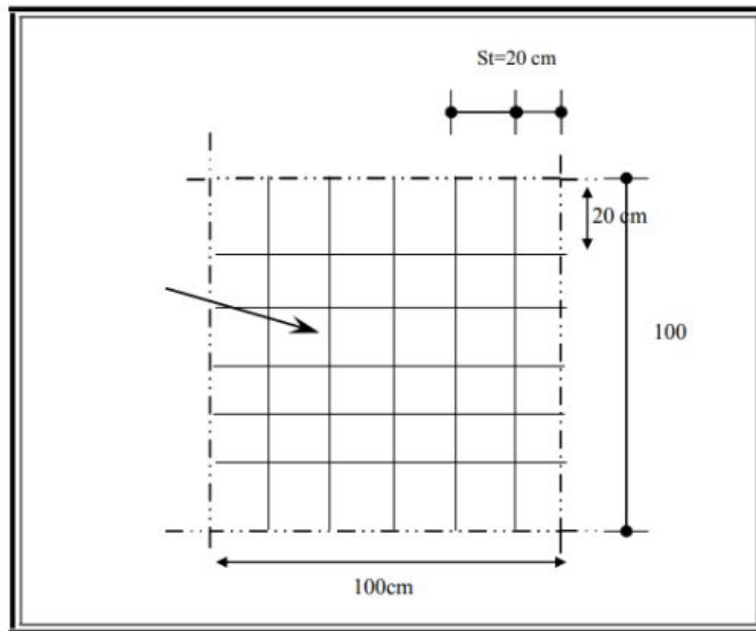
Disposition constructive des armatures de la dalle de compression
